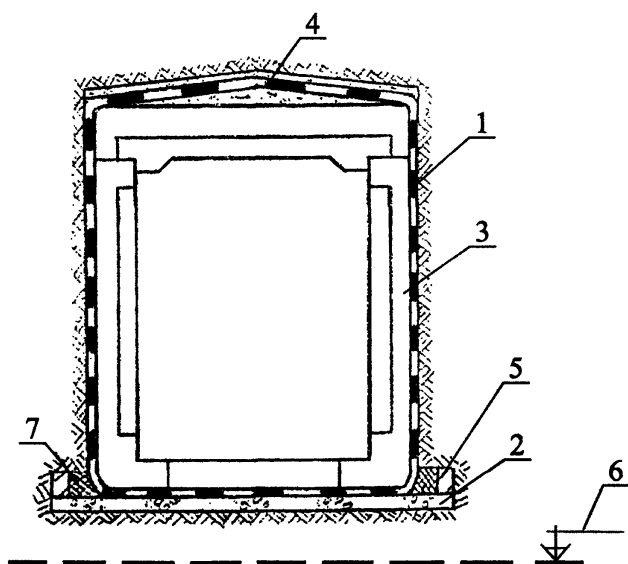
Гидроизоляция подземных сооружений от грунтовой капиллярной влаги
